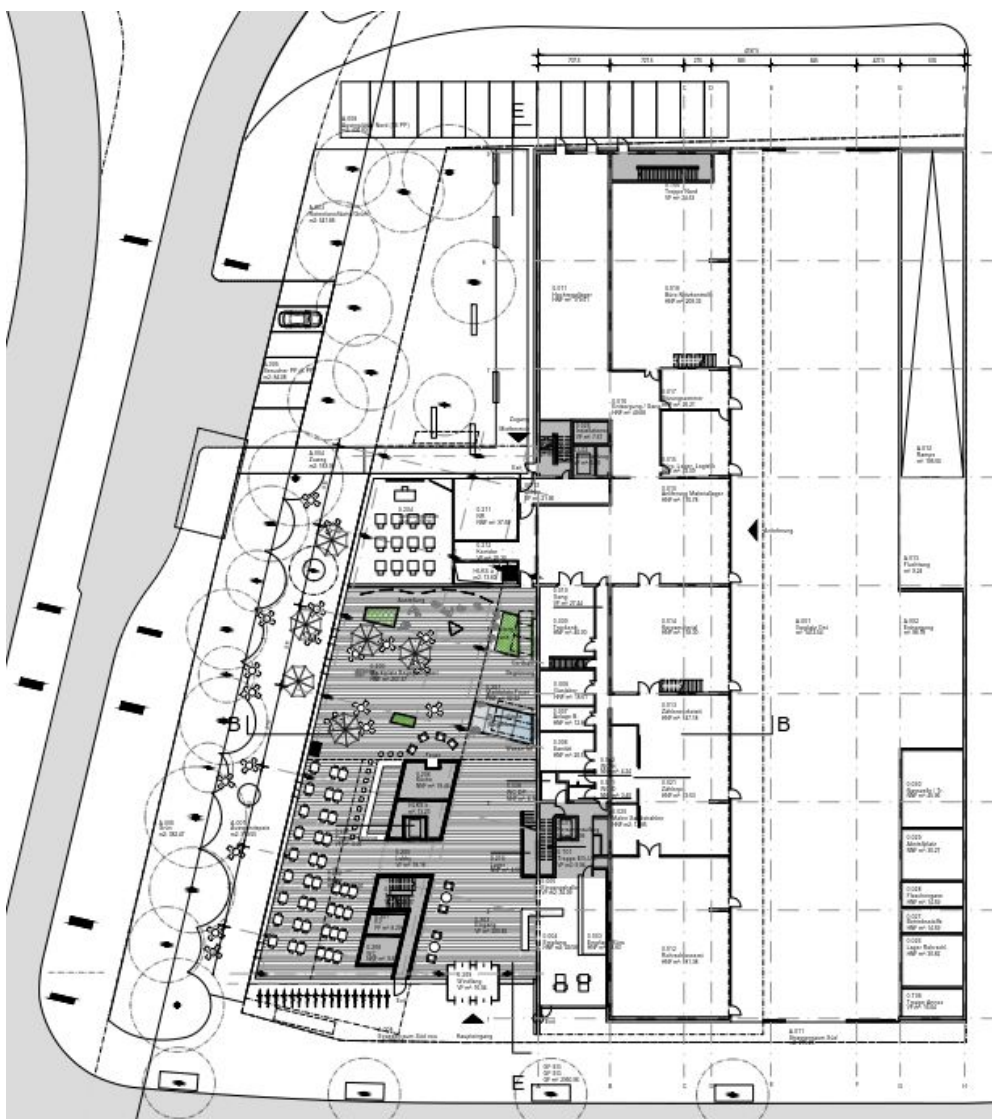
Grundriss Variante 2.0, Erdgeschoss; inklusive Bistro und Aussenbereich
